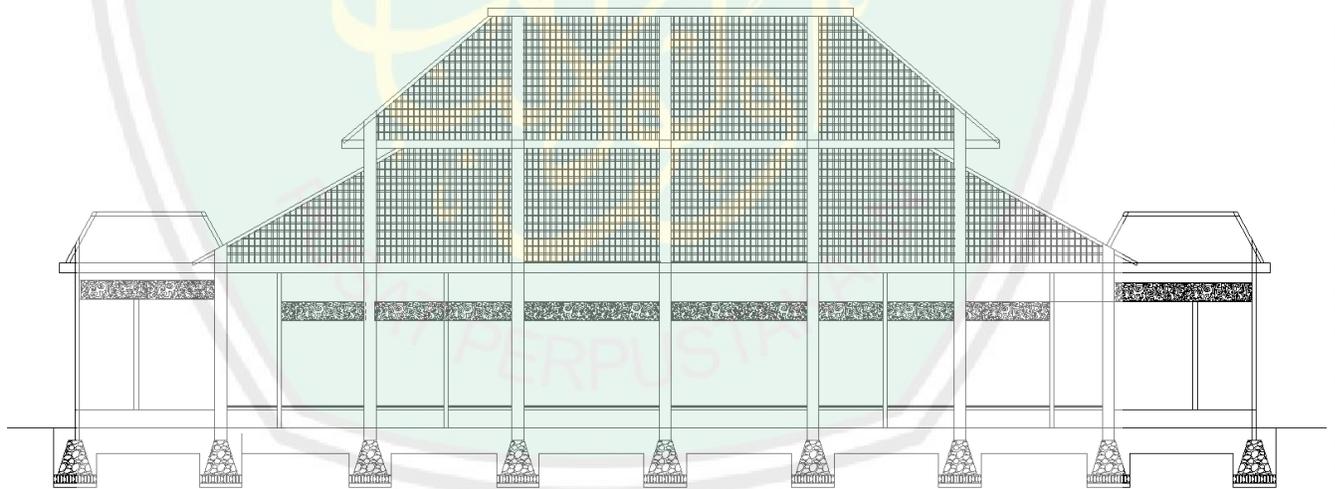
35 Detail Struktur Pondasi Batu Kali
